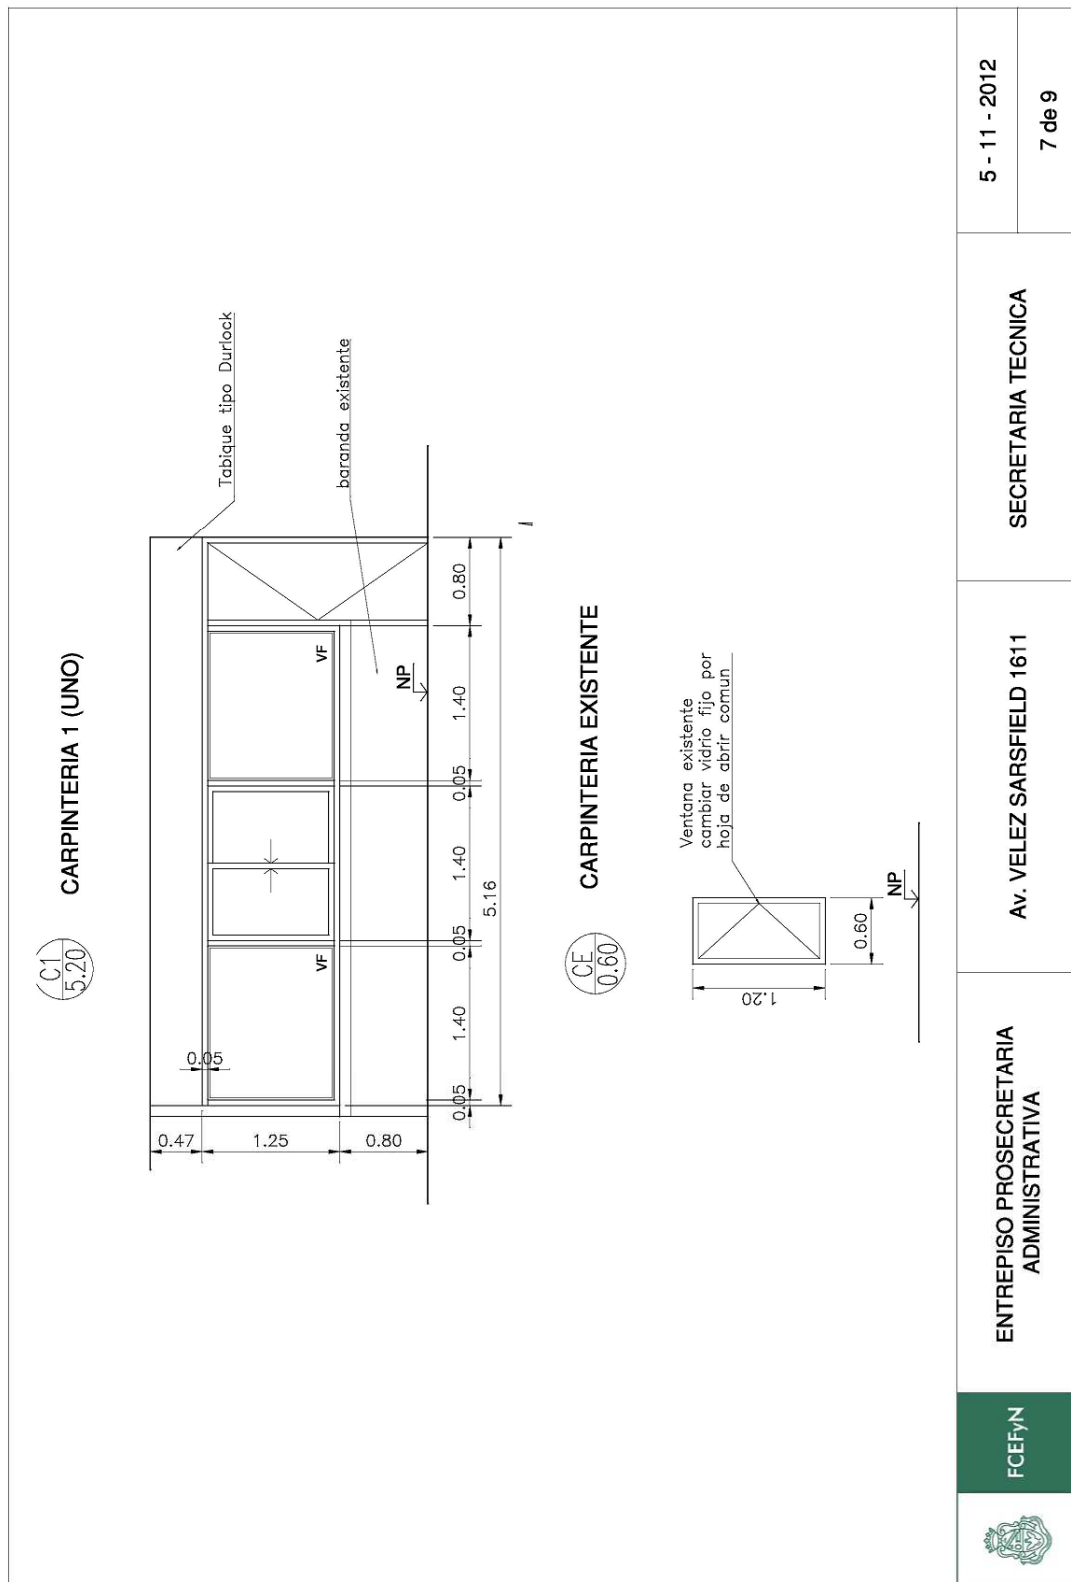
Plano 7 – Fuente: Digitalización de planos originales
